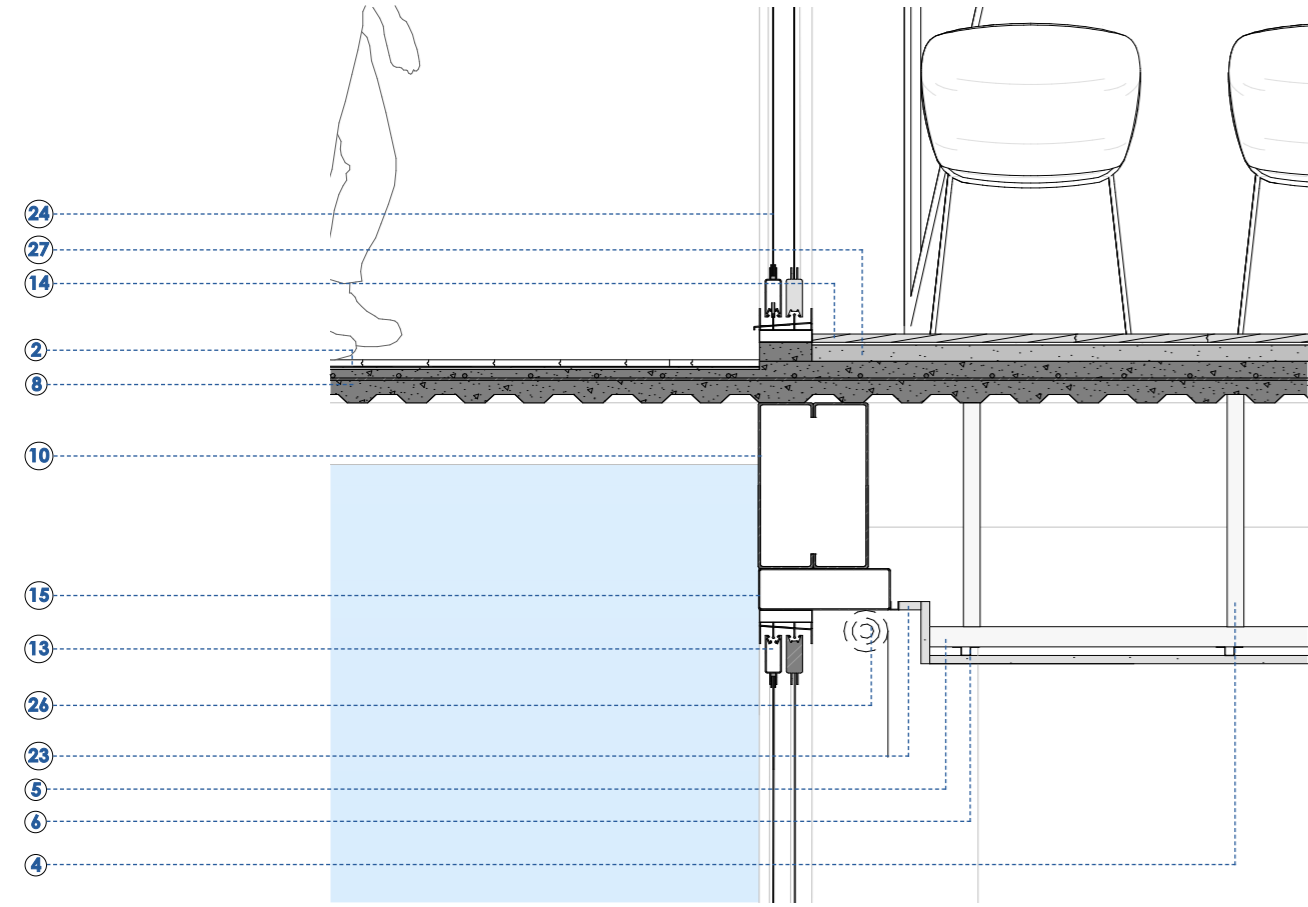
Detalle Constructivo C-3. Fuente: Elaboración propia (2026)
